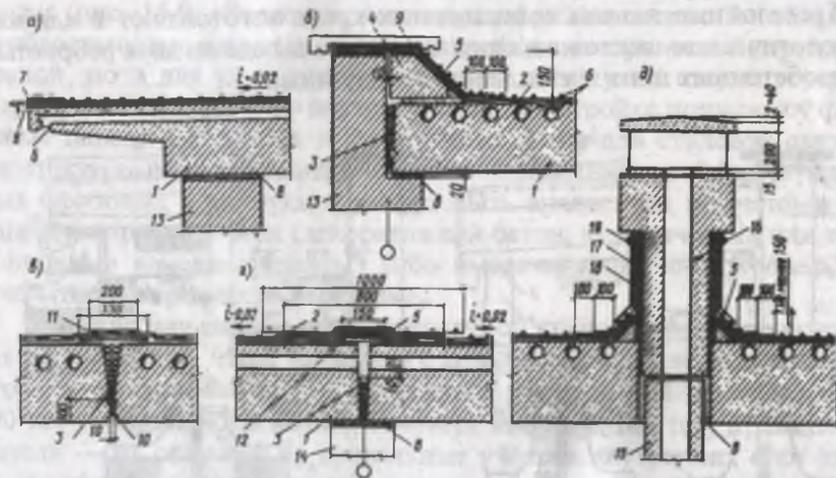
Детали устройства гидроизоляционного рулонного покрытия бесчердачной крыши из вентилируемых легкобетонных панелей при устройстве карниза (а), парапета (б), в стыках кровельных панелей в пролете (в), на опоре (г), в пересечениях крыши вентиляционным блоком (д):
